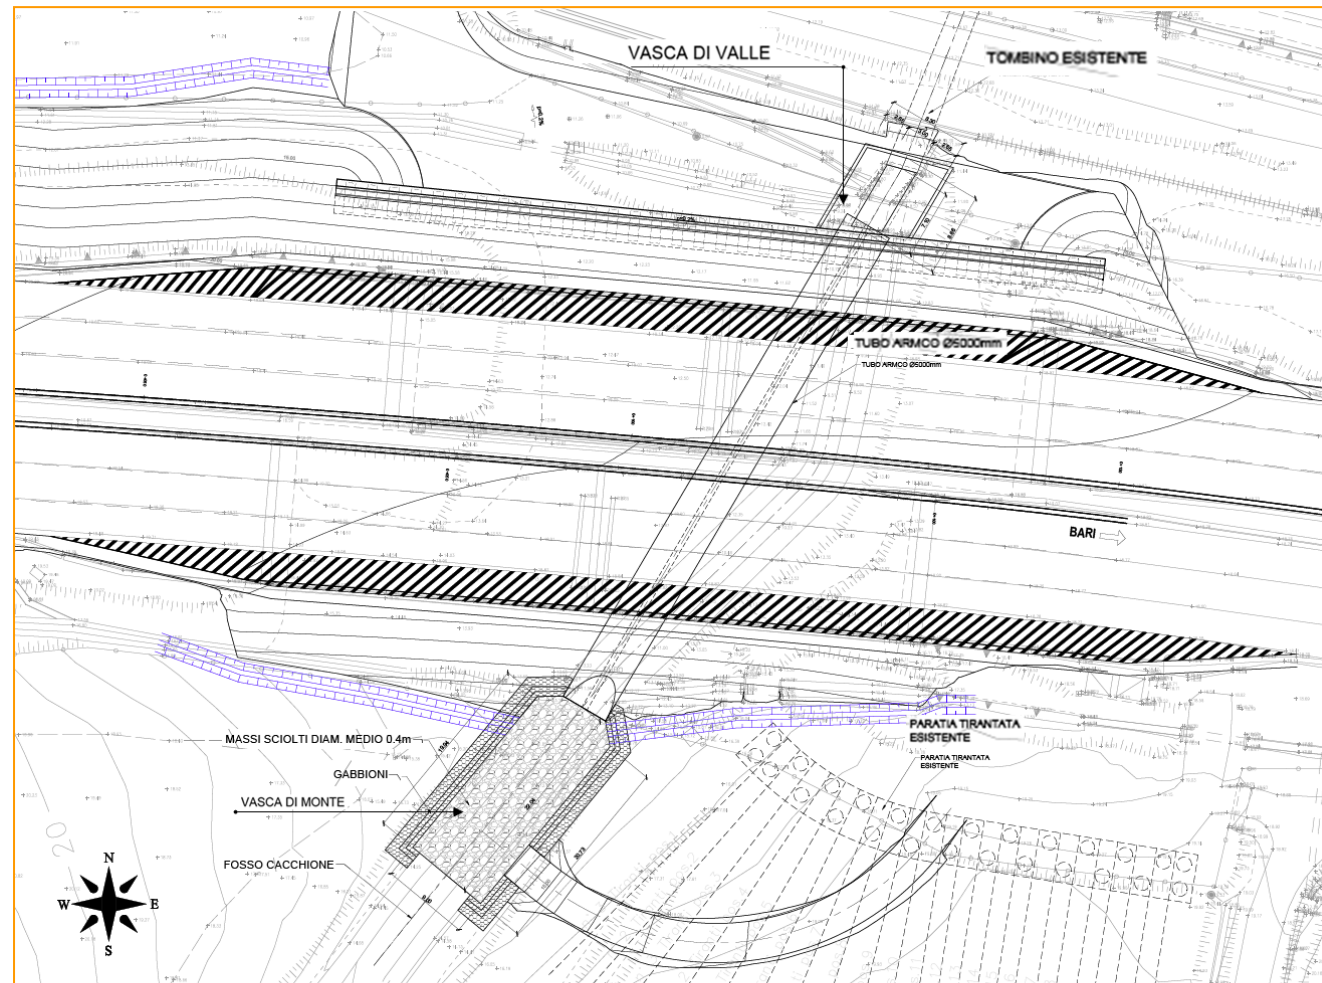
Planimetria sistemazione idraulica fosso Cacchione
